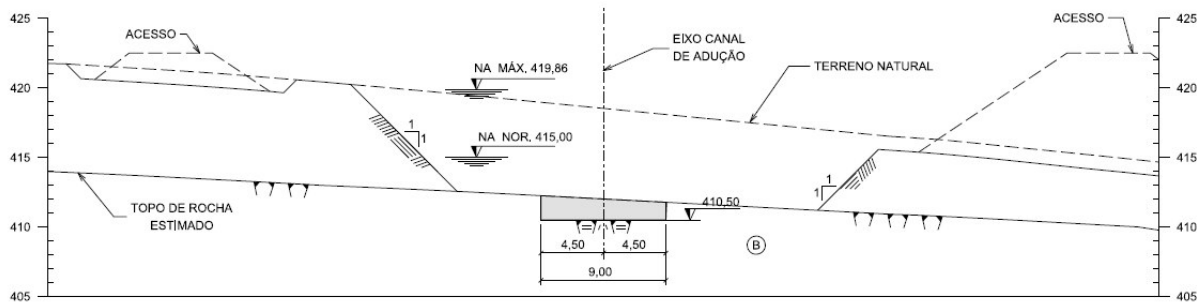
Seção típica de escavação em rocha e solo ao longo do canal de adução
